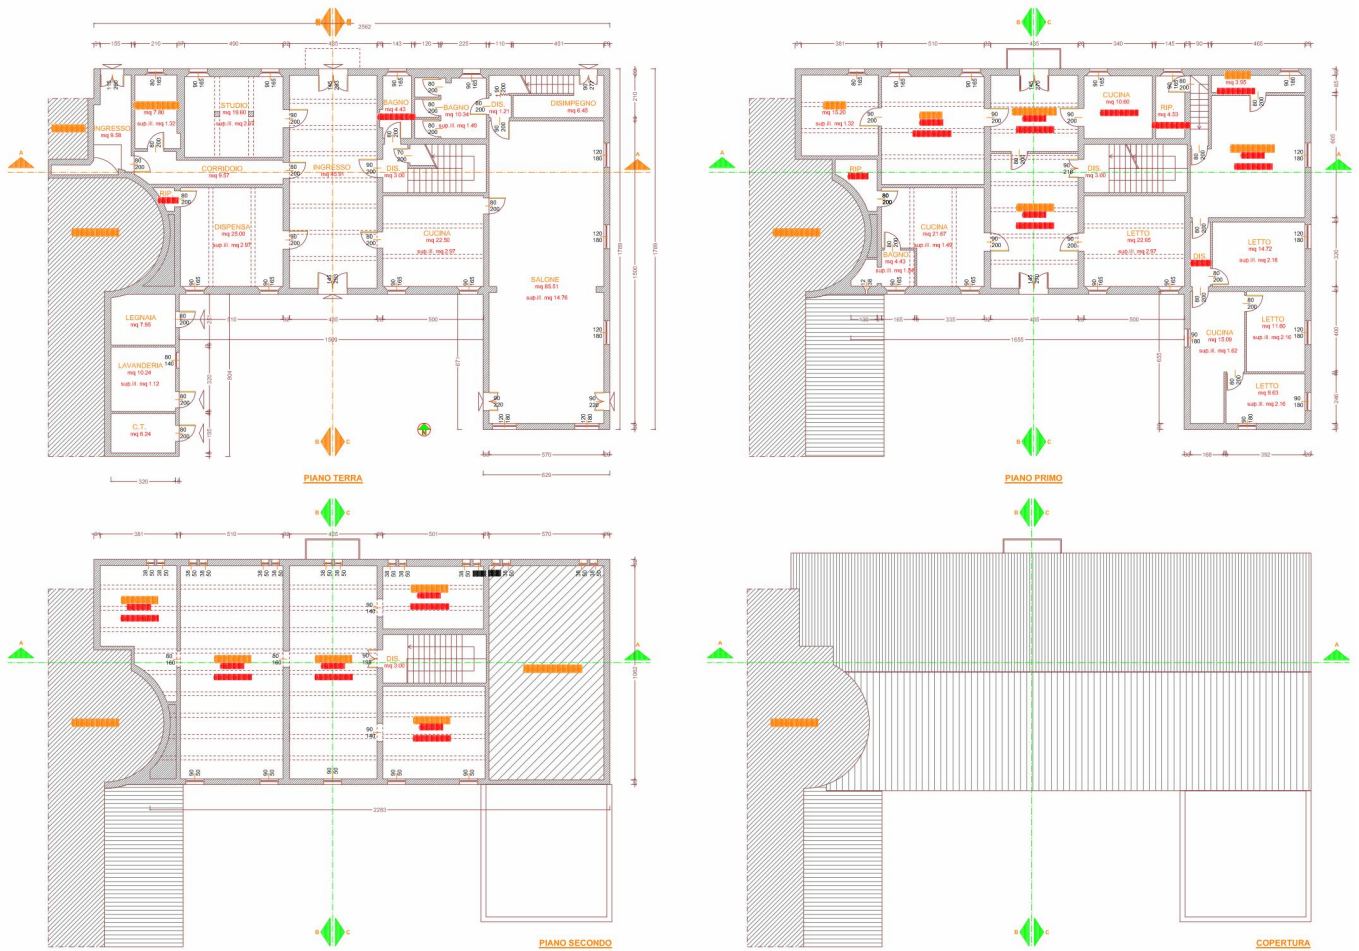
Stralcio catastale con ubicazione prava – Piante di progetto
